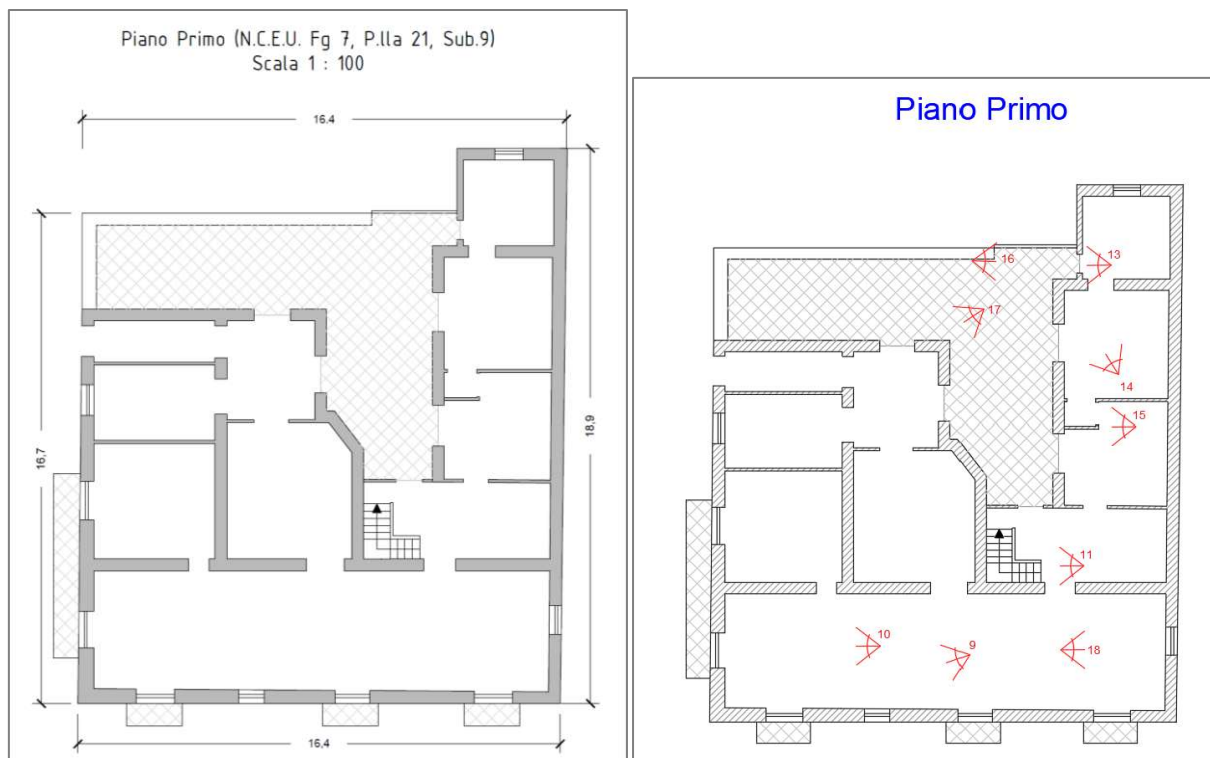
e 16- Pianta Piano primo e pianta con coni ottici
